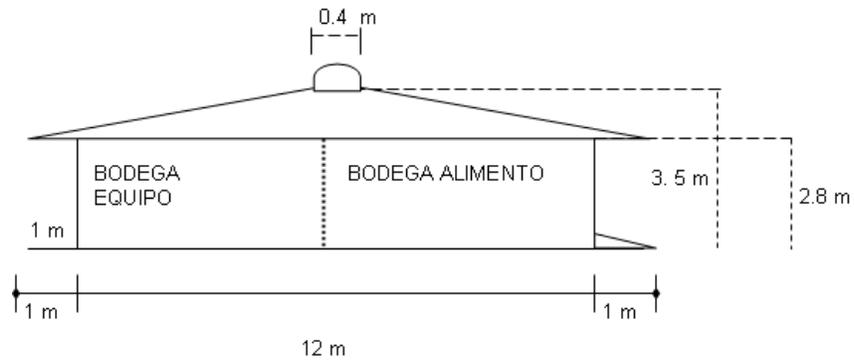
FACHADA POSTERIOR, LADO NORTE
